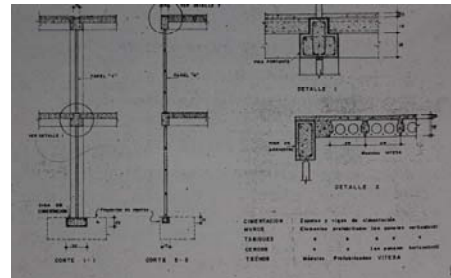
Sistema Constructivo I-5 de PREVI, base parcial de la propuesta constructiva, fuente, ministerio de vivienda.
